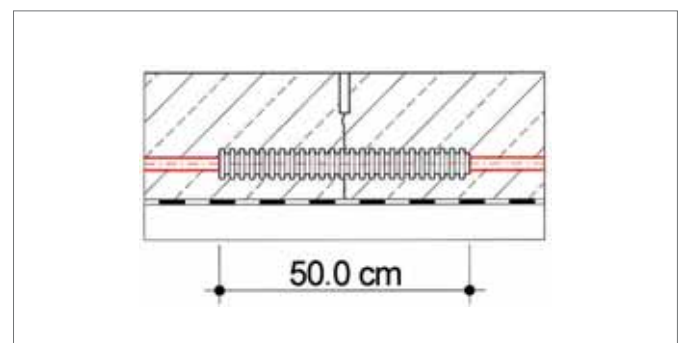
Junta parcial, junta de construcción con tubo protector
